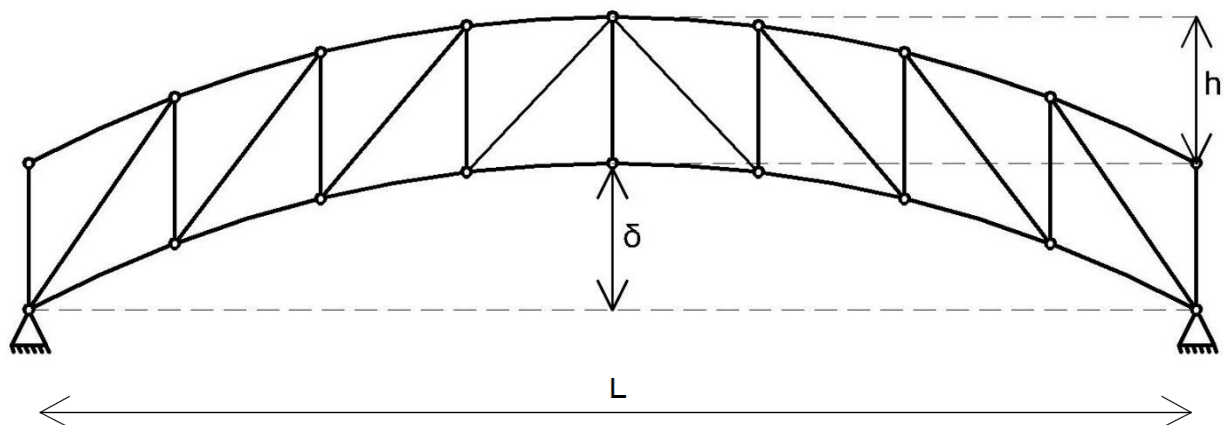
Treliza de cobertura tipo Howe Inclinada.
